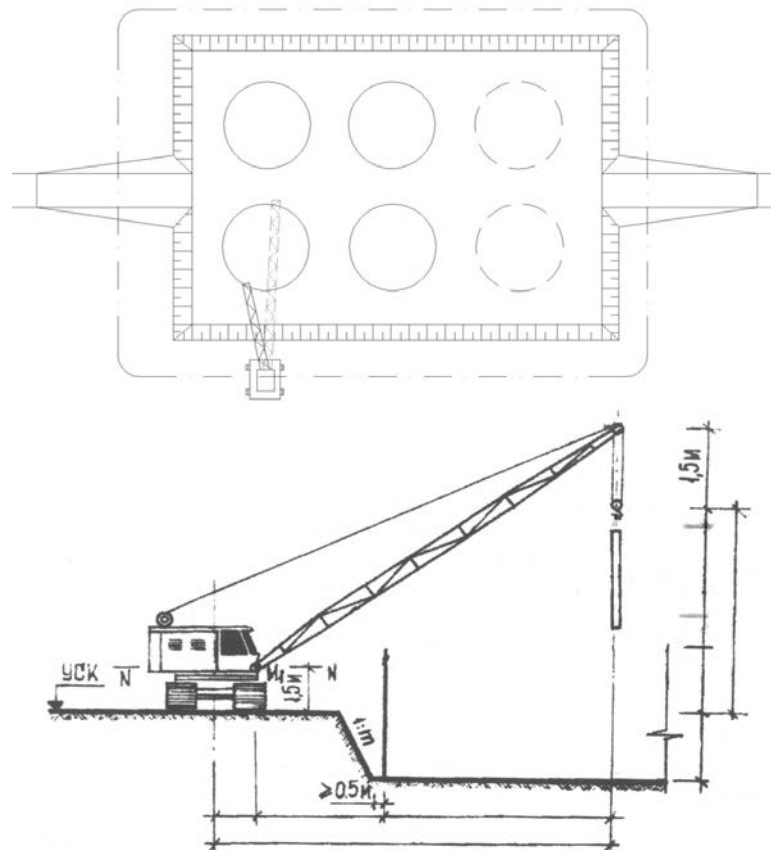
Кран расположен на борке котлована и перемещается по его периметру
